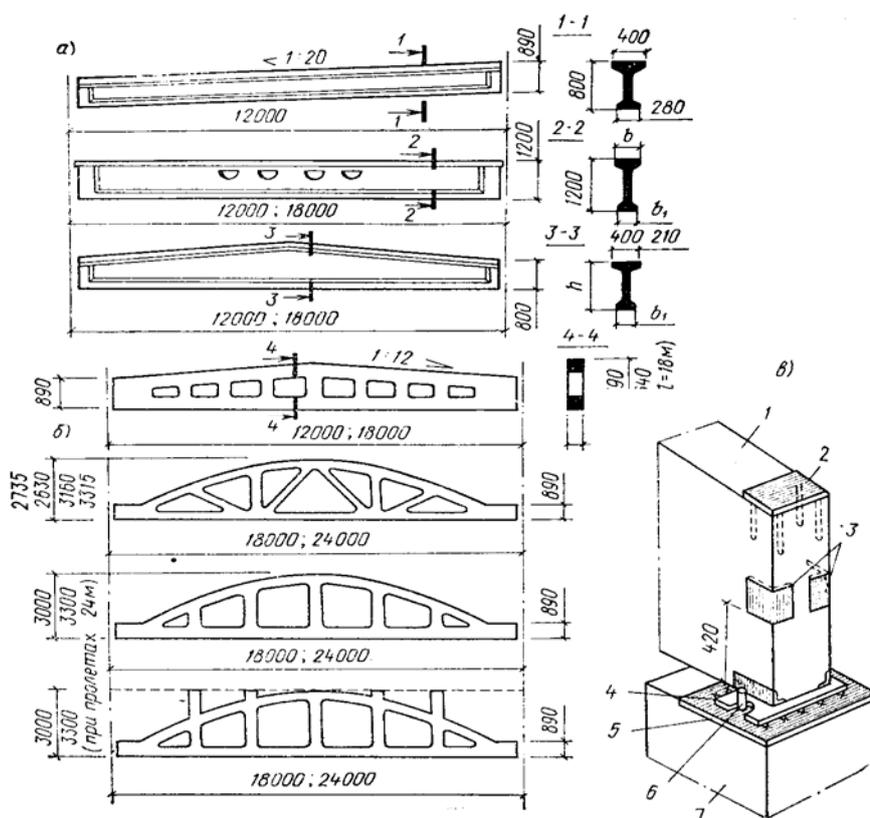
Сборные железобетонные балки и фермы покрытия:
